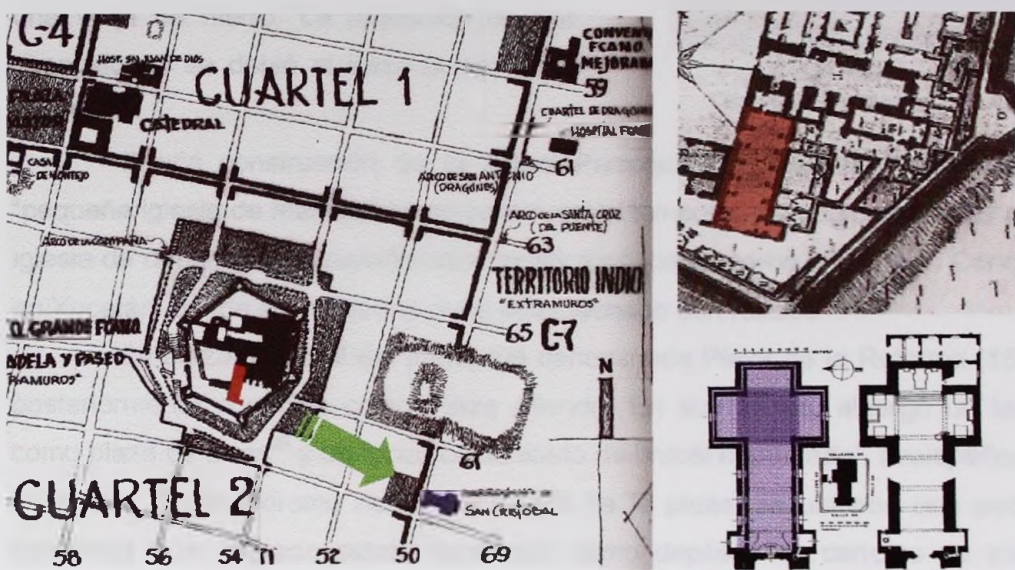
Plano del Barrio de San Cristóbal de 1788, con la ubicación de la primera Parroquia, dentro del Convento de San Francisco, y la actual Parroquia.
